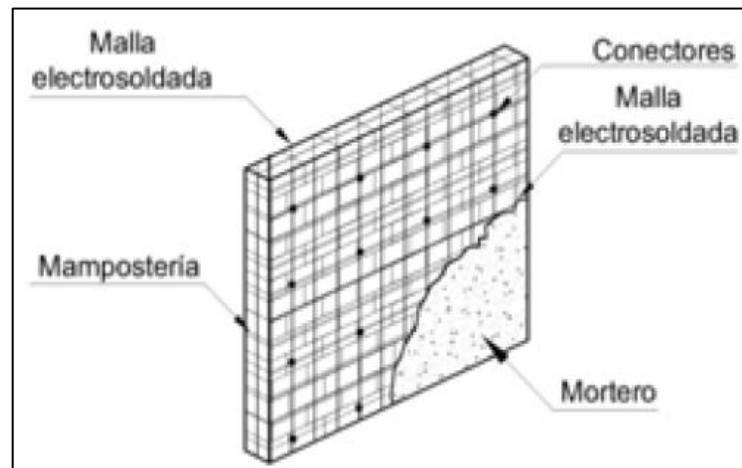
Mampostería reforzada con malla electrosoldada y recubierta con mortero.
